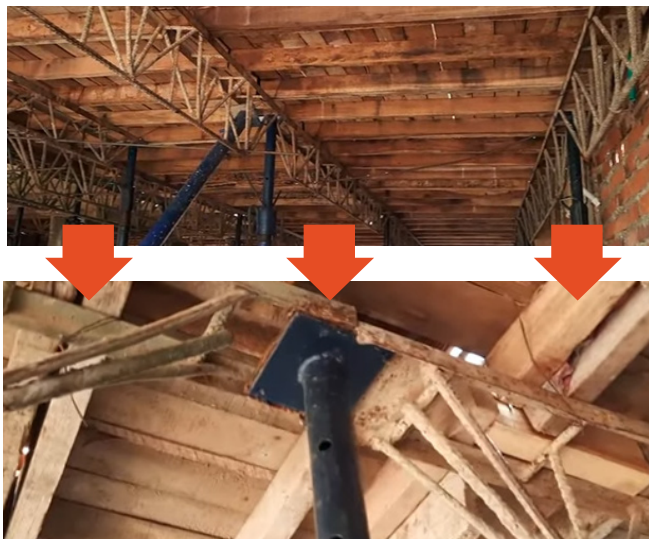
ejemplo de refuerzo de vigueta con estribos, refuerzo longitudinal superior e inferior.
